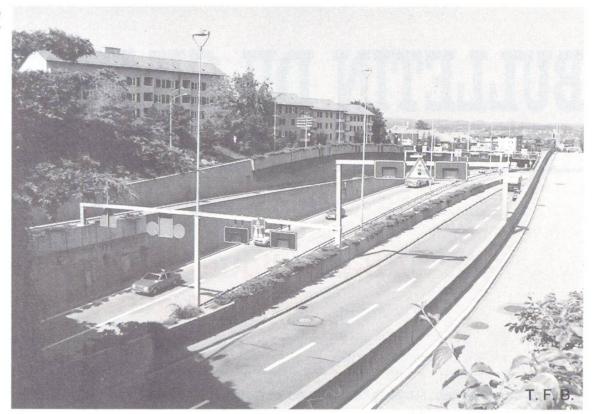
Les murs de soutènement ne doivent être construits qu'aux endroits où d'autres solutions ne sont pas défendables du point de vue économique (N1 à Zurich, tunnel du Milchbuck, portail nord). Murs de soutènement entre trois voies de trafic étagées.
